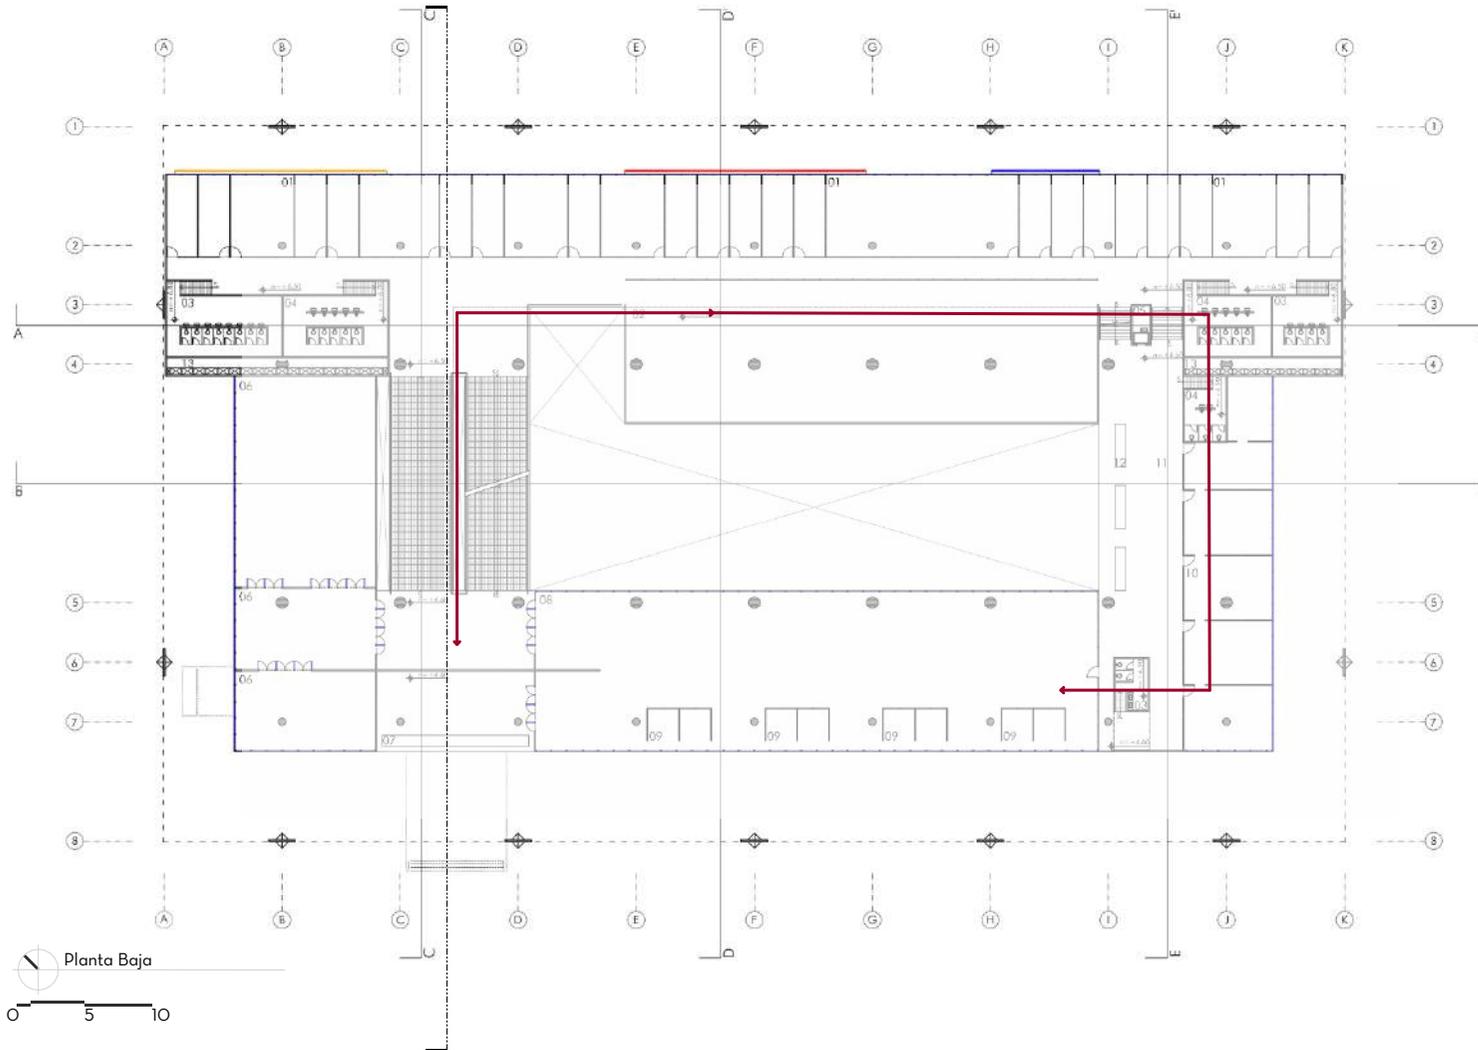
Planta Baja FAU donde se puede ver el acceso desde la Calle del Lago hacia las rampas de circulación. Autores de dibujo base: Ana Llerena; Isabel Carrasco
